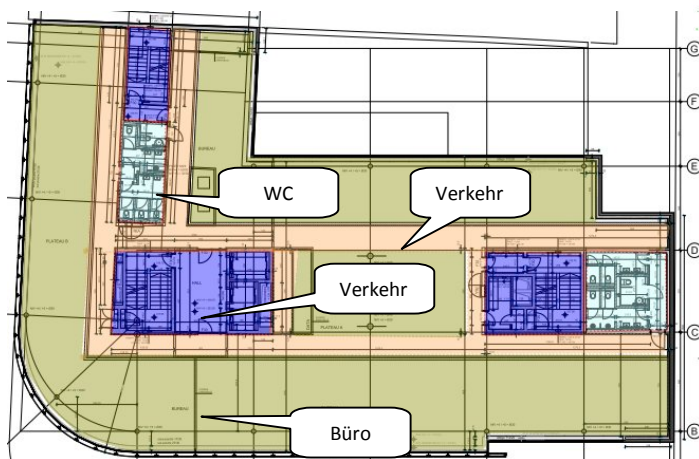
Grundriss Regelgeschoss mit Zonierung, Geb.4³
